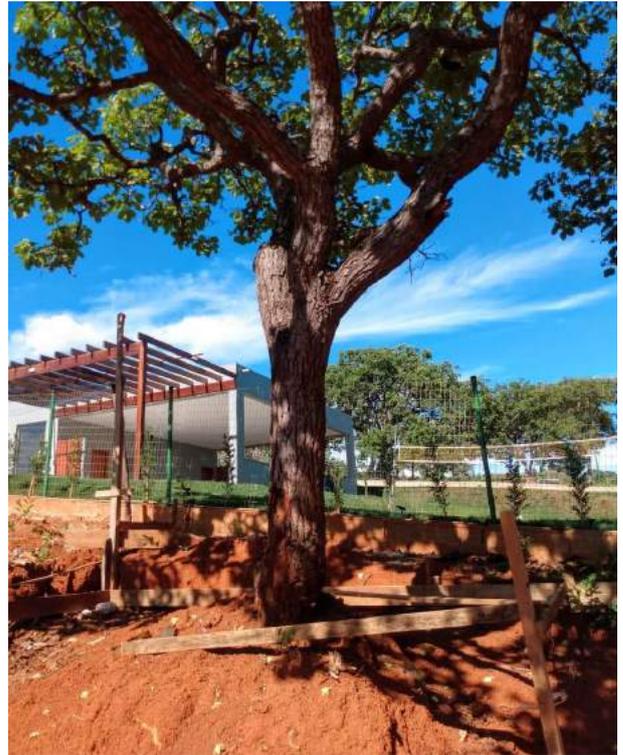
Pequizeiro situado na lateral esquerda e com exposição de raízes e passível de supressão.
